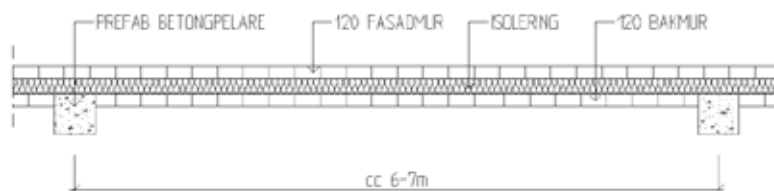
Elevationsskiss som visar hur väggen ursprungligen varit kramlad.
